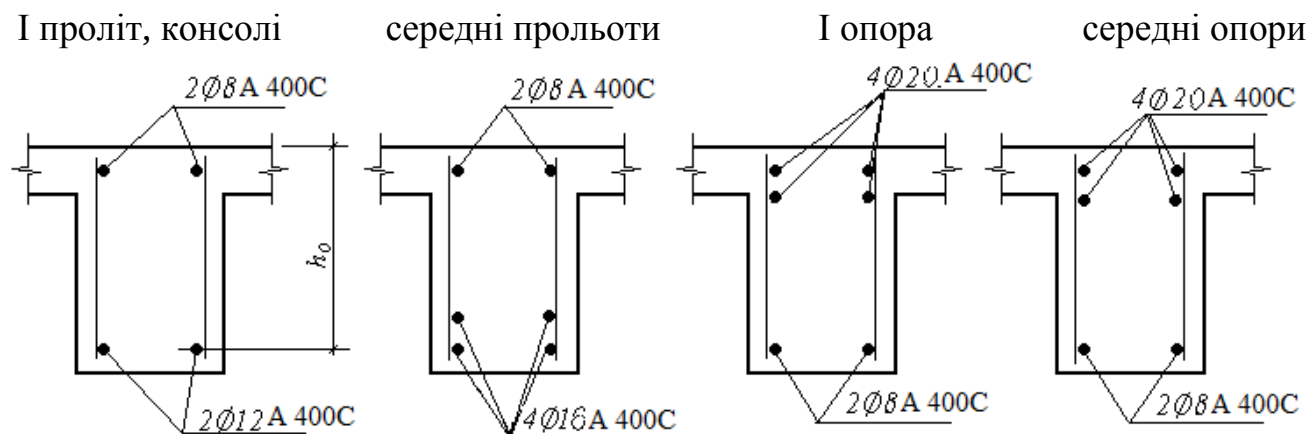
Армування другорядної балки зварними каркасами
